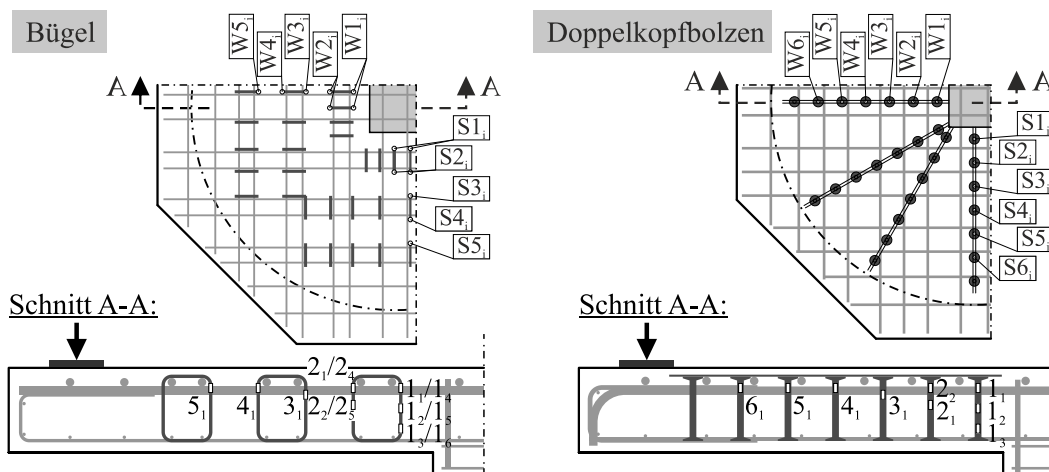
Anordnung der Dehnungsmessstreifen der Durchstanzbewehrung im Grundriss und im Schnitt: geschlossene Bügel (links) und Doppelkopfbolzen (rechts)
